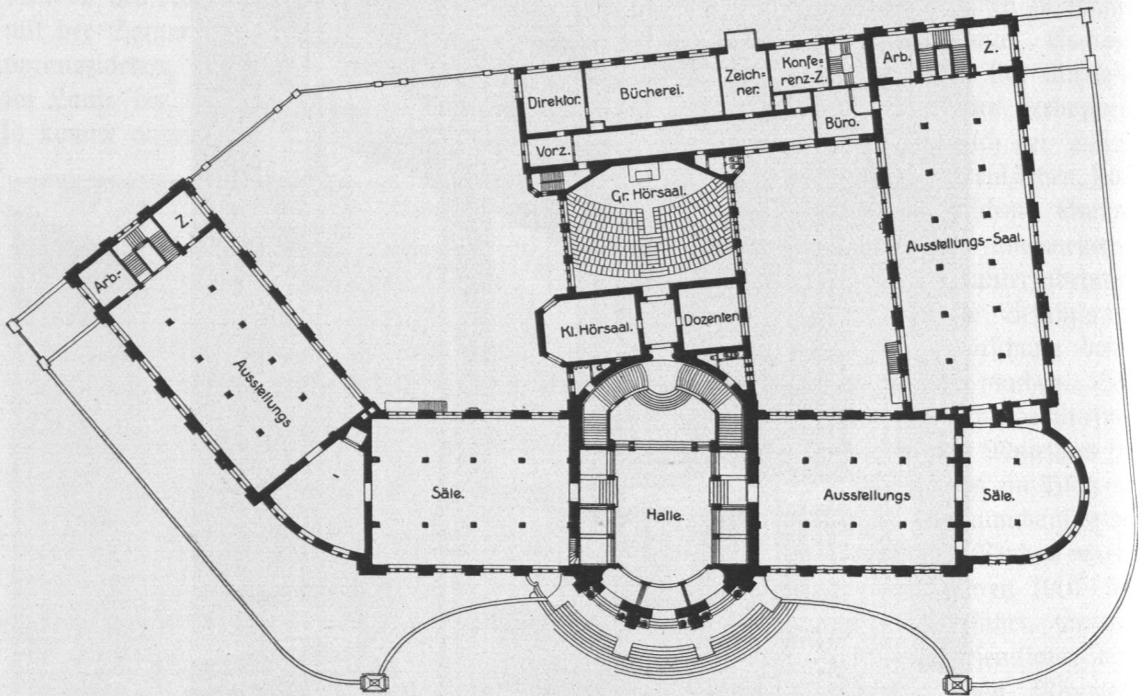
Museum für Völkerkunde, Erdgeschoss, Grundriß.
